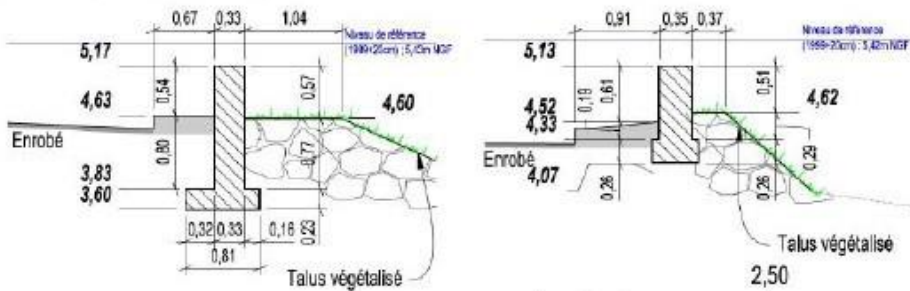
Profils en travers des murets béton sur le tronçon 3
